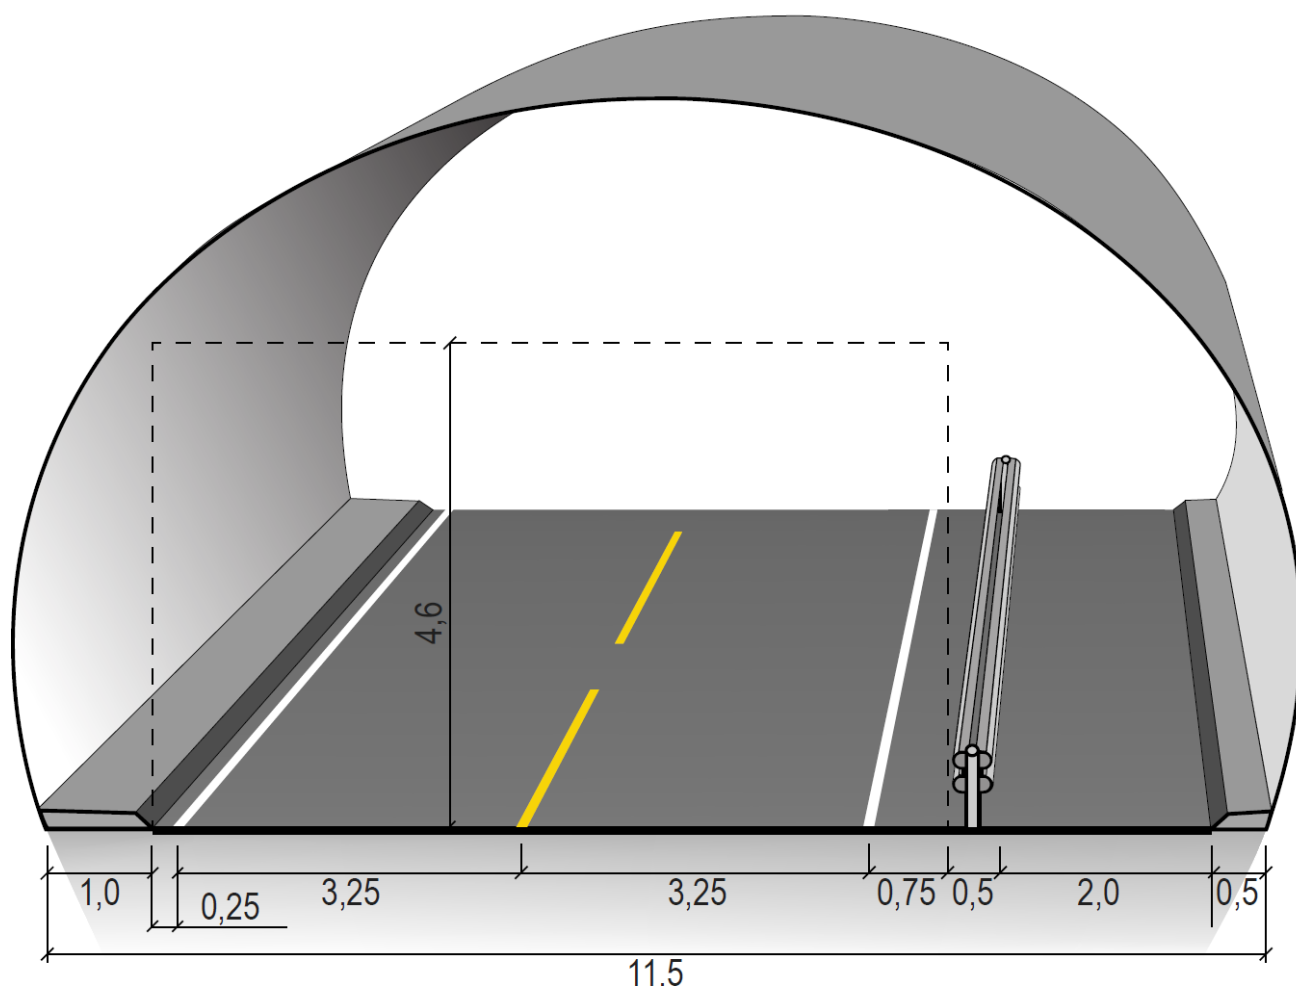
Tunnelprofil T12,5 med havarinisje (mål i m).
